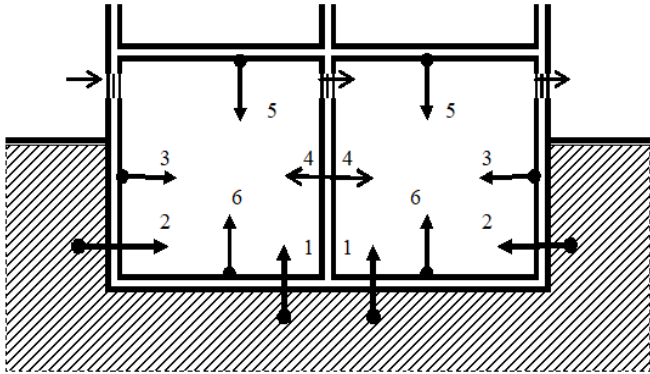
Расчетная схема здания и источники поступлений радона: 1 — грунтовое основание; 2 — грунт, примыкающий к фундаментным стенам; 3, 4 — продольные и поперечные фундаментные стены, 5 — перекрытие, 6 — конструкция опирающегося на грунт пола
